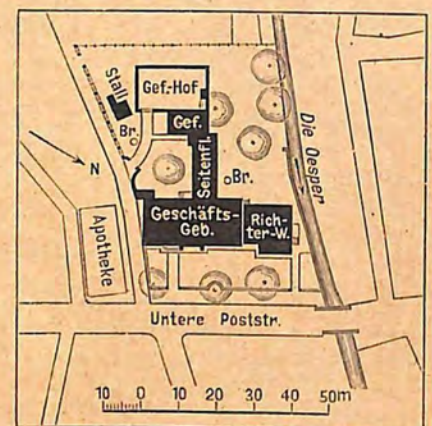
Amtsgericht in Petershagen. Lageplan.
